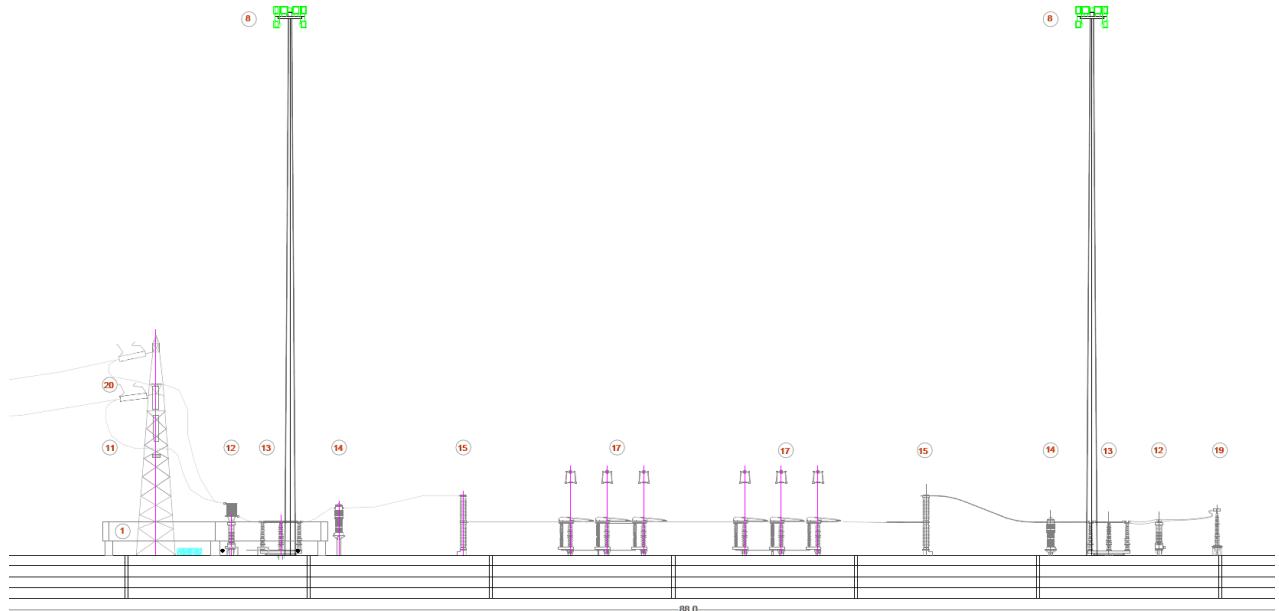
Prospetto della nuova Stazione Elettrica 150 kV
